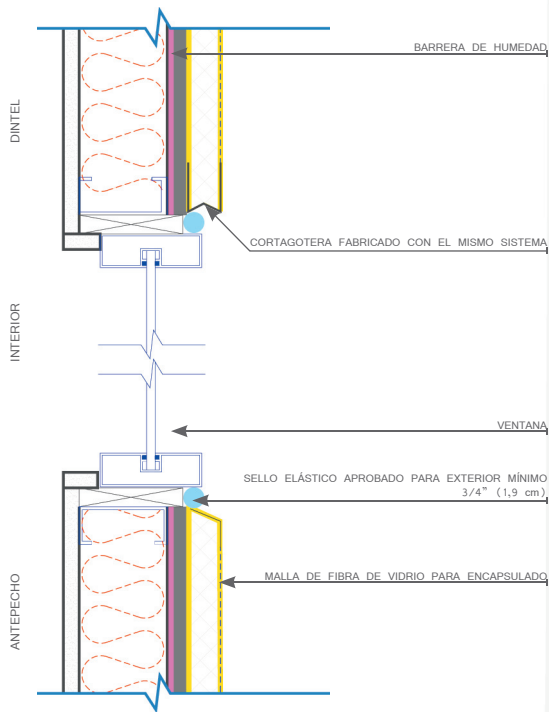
i: Detalle constructivo de encuentro con vanos, sistema EIFS de barrera, (vista corte vertical).
